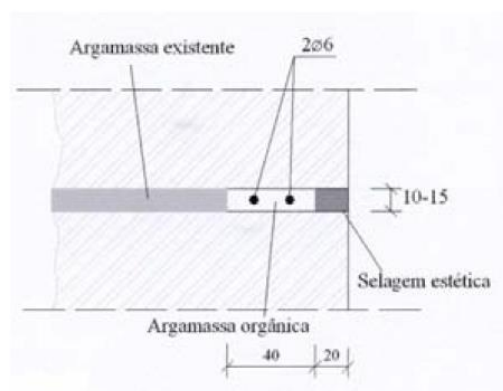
Pormenor de refechamento de juntas com armadura e aplicação de uma camada de argamassa sintética com selagem exterior (valores em mm)
